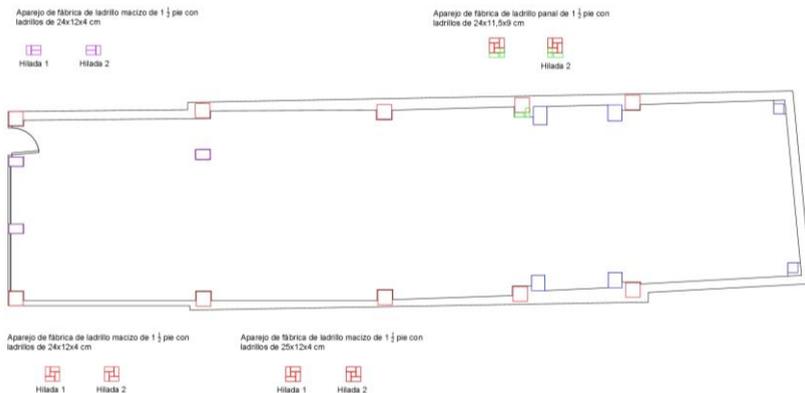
Plano de distribución de pilares en Planta baja. 2018. Fuente: Propia
